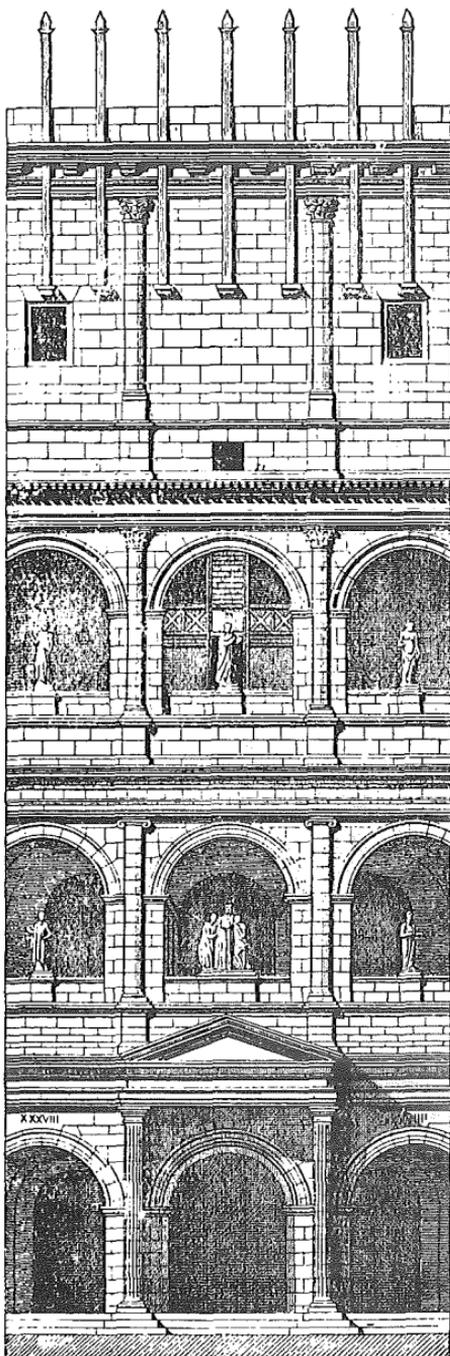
Una parte de la fachada del Coliseo. (Restauración de Duc).
